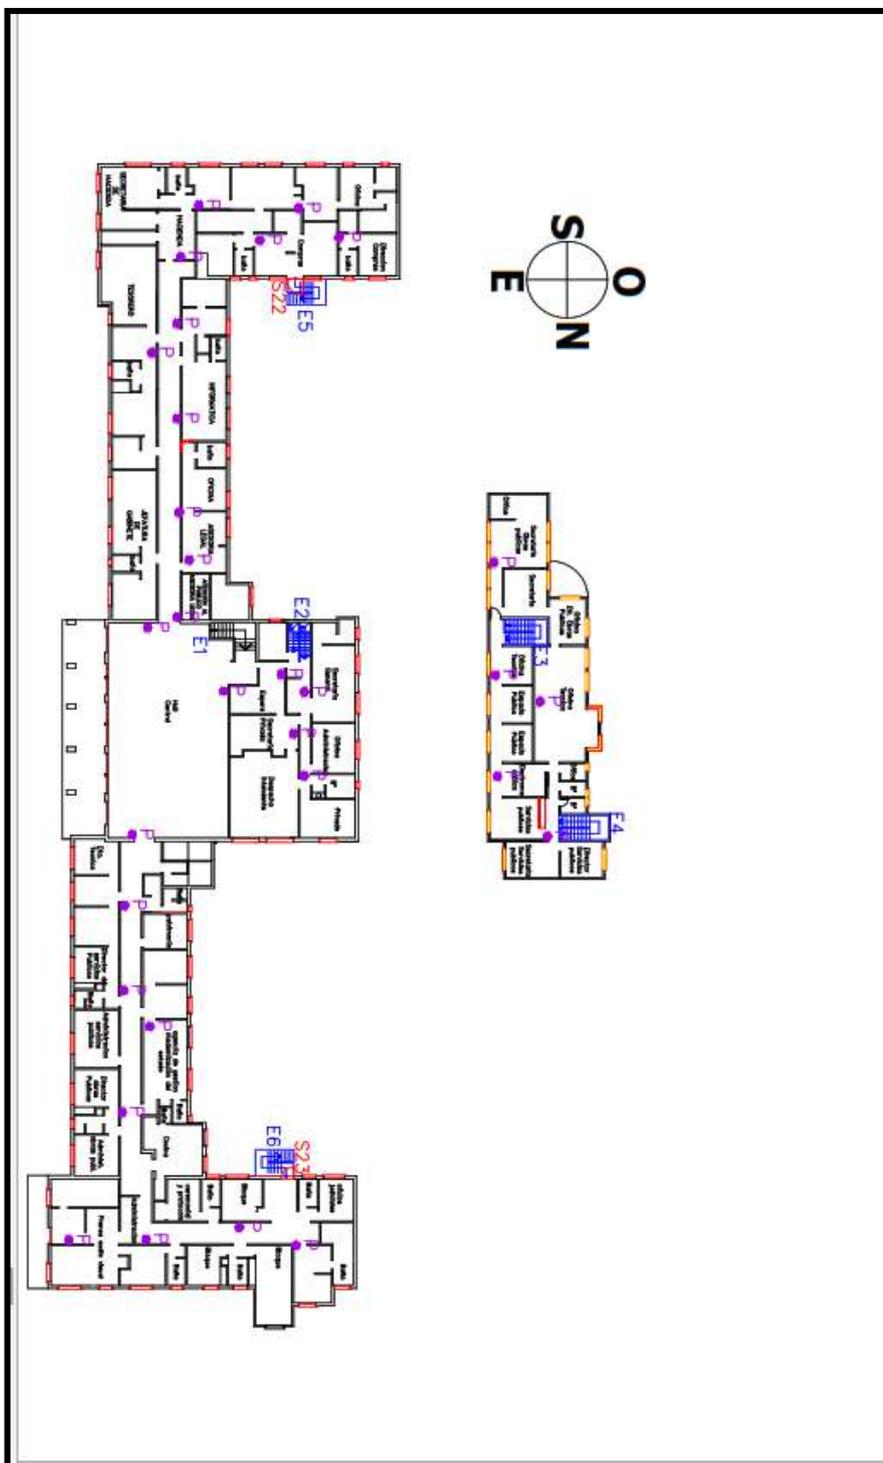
Imagen XV. Planta Alta. Sistema de pulsadores de emergencia
